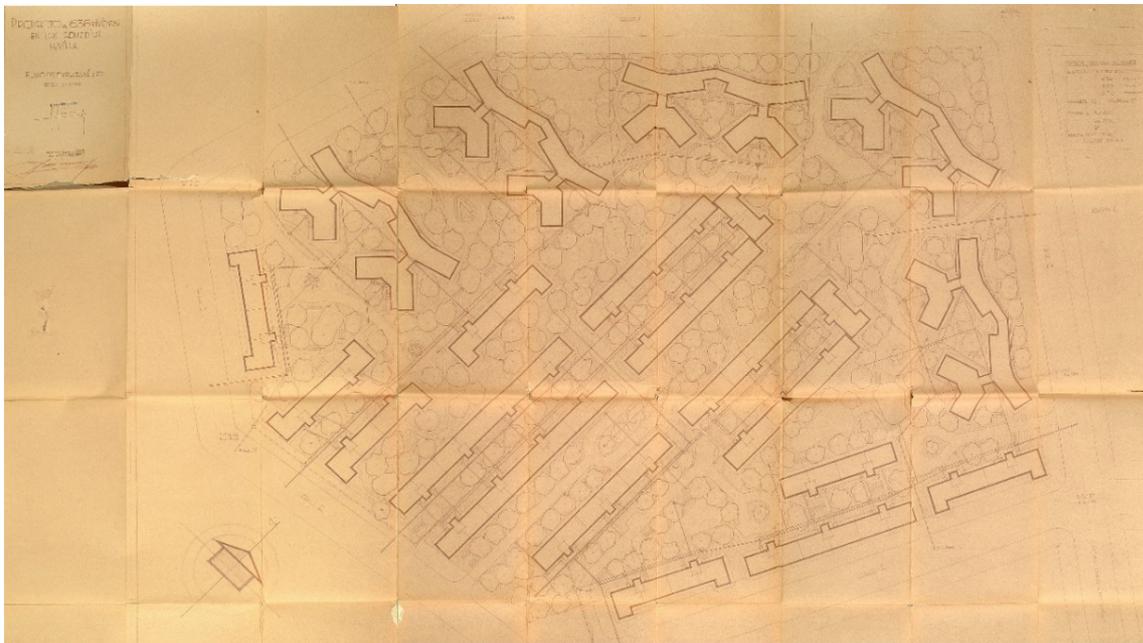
Proyecto original para El Carmen. Luis Recasens Méndez Queipo de Llano. Plano: ICAS-SAHP, Archivo Municipal de Sevilla, Obras de particulares.
